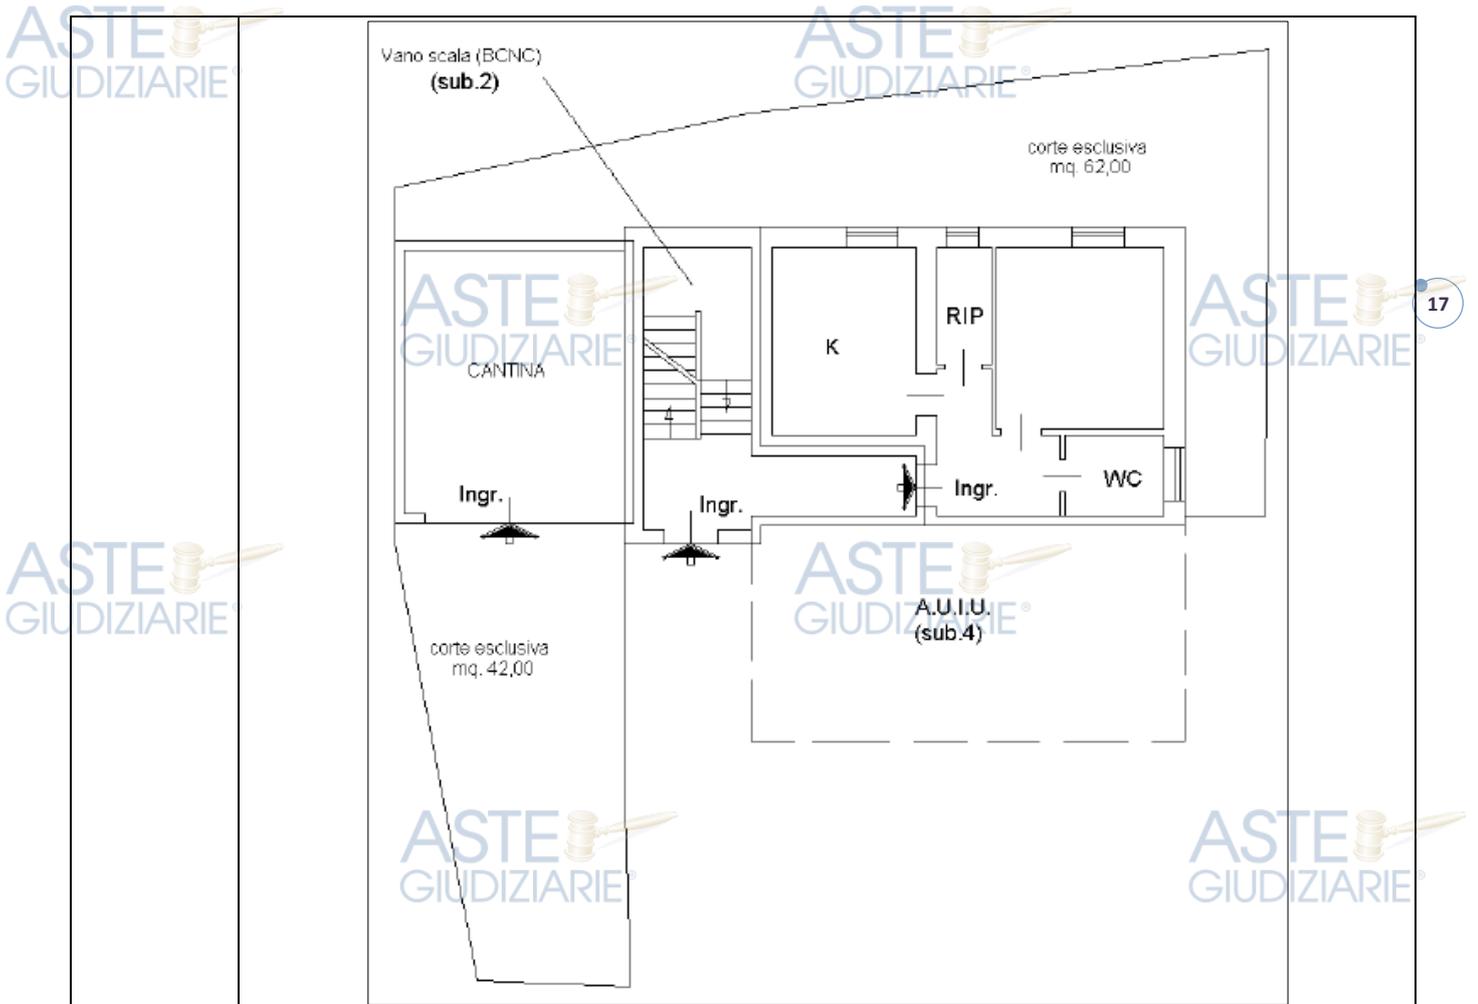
Planimetria catastale estratta dall'Agenzia delle Entrate.
